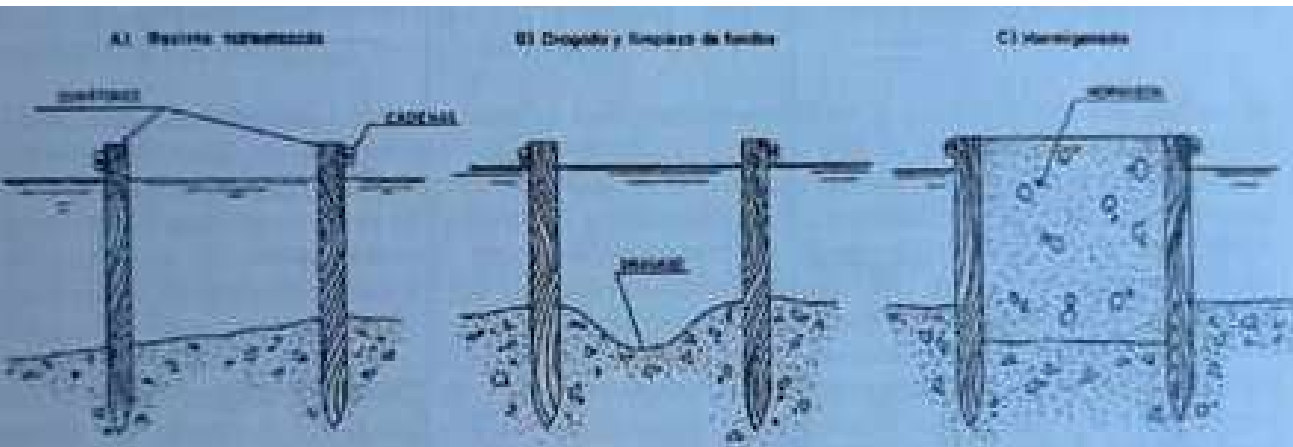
Proceso constructivo de un dique vertical o muelle de hormigón en masa según Vitrubio (V-13).
